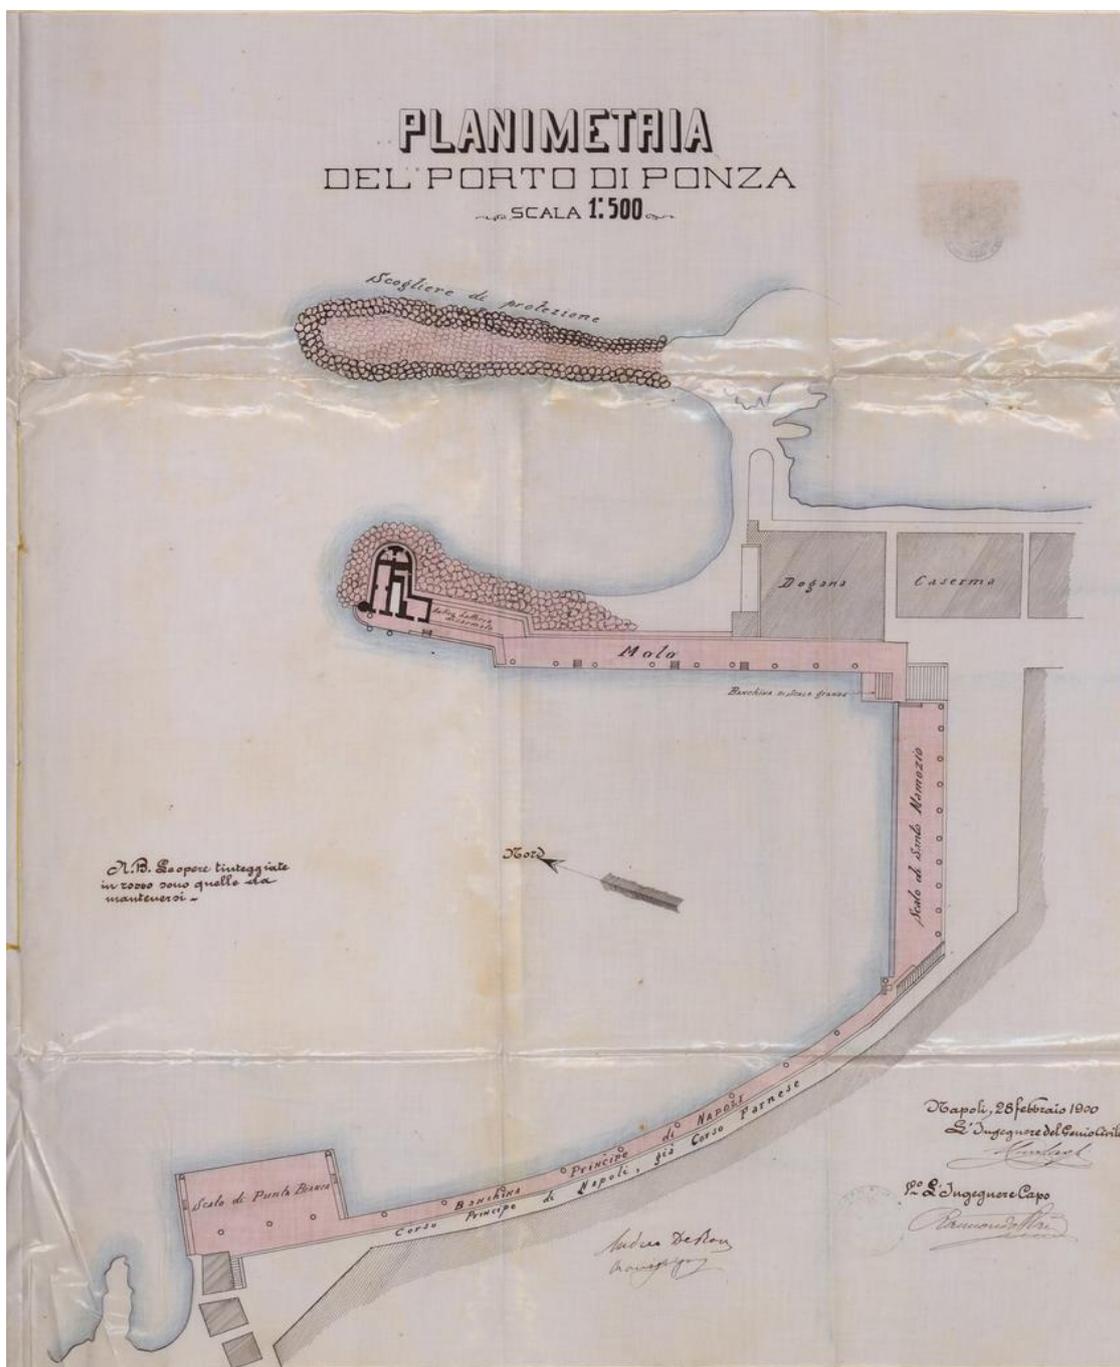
Progetto dei lavori occorrenti al restauro ed alla manutenzione delle opere d'arte del Porto di Ponza. Planimetria del Porto.¹⁵
